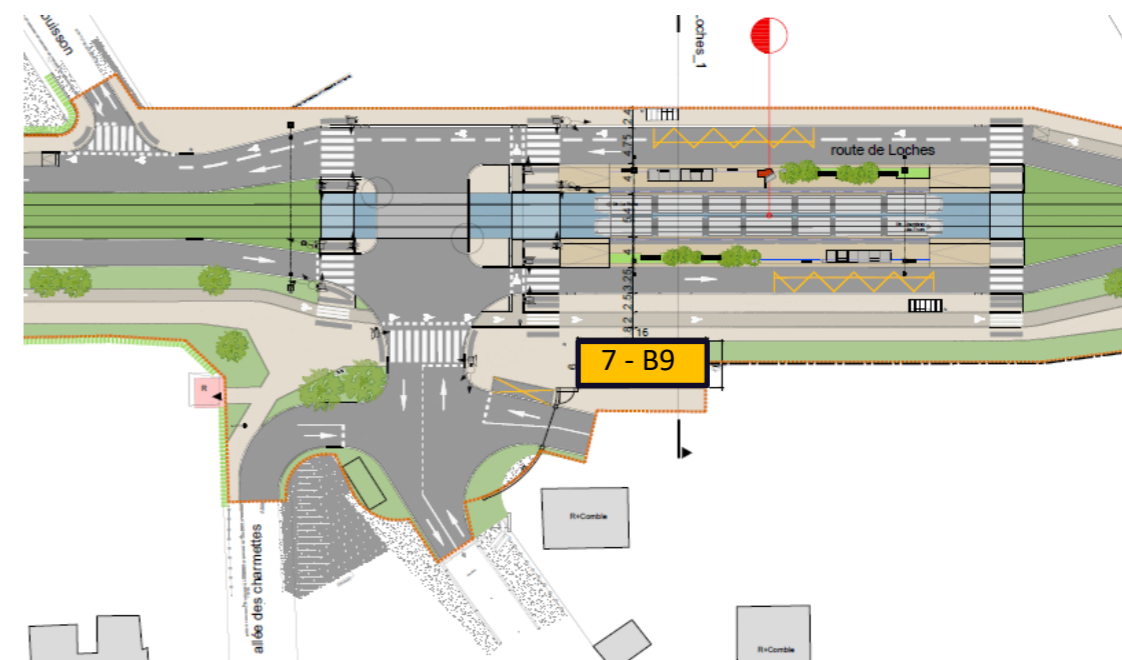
plan de localisation provisoire la station SSR 7-B9
